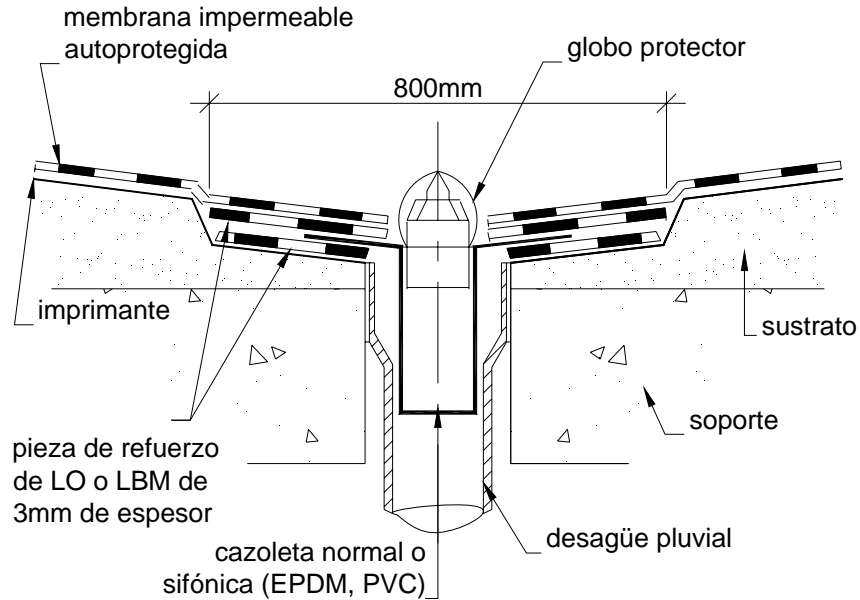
Remate con tragante prefabricado - Cazoleta para membrana autoprotegida
